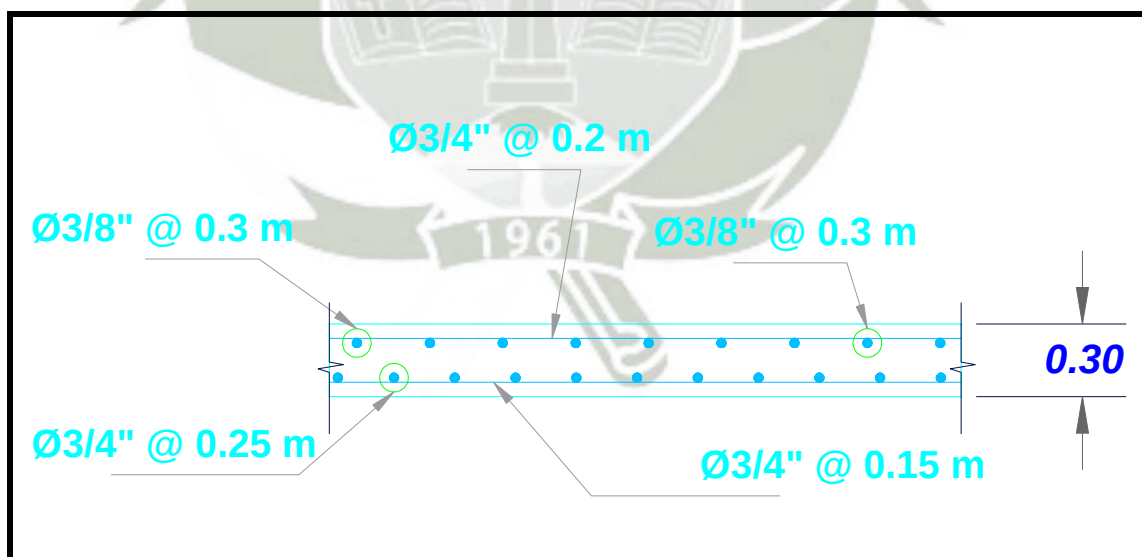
Diseño en Concreto Armado – Losa Superior del Tablero de Puente
